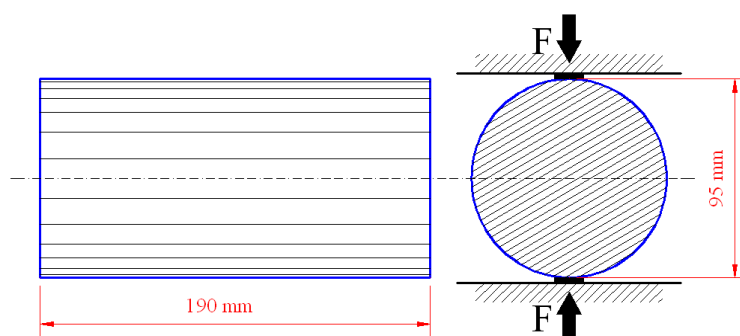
Esquema de ensaio e dimensões – tração por compressão diametral
